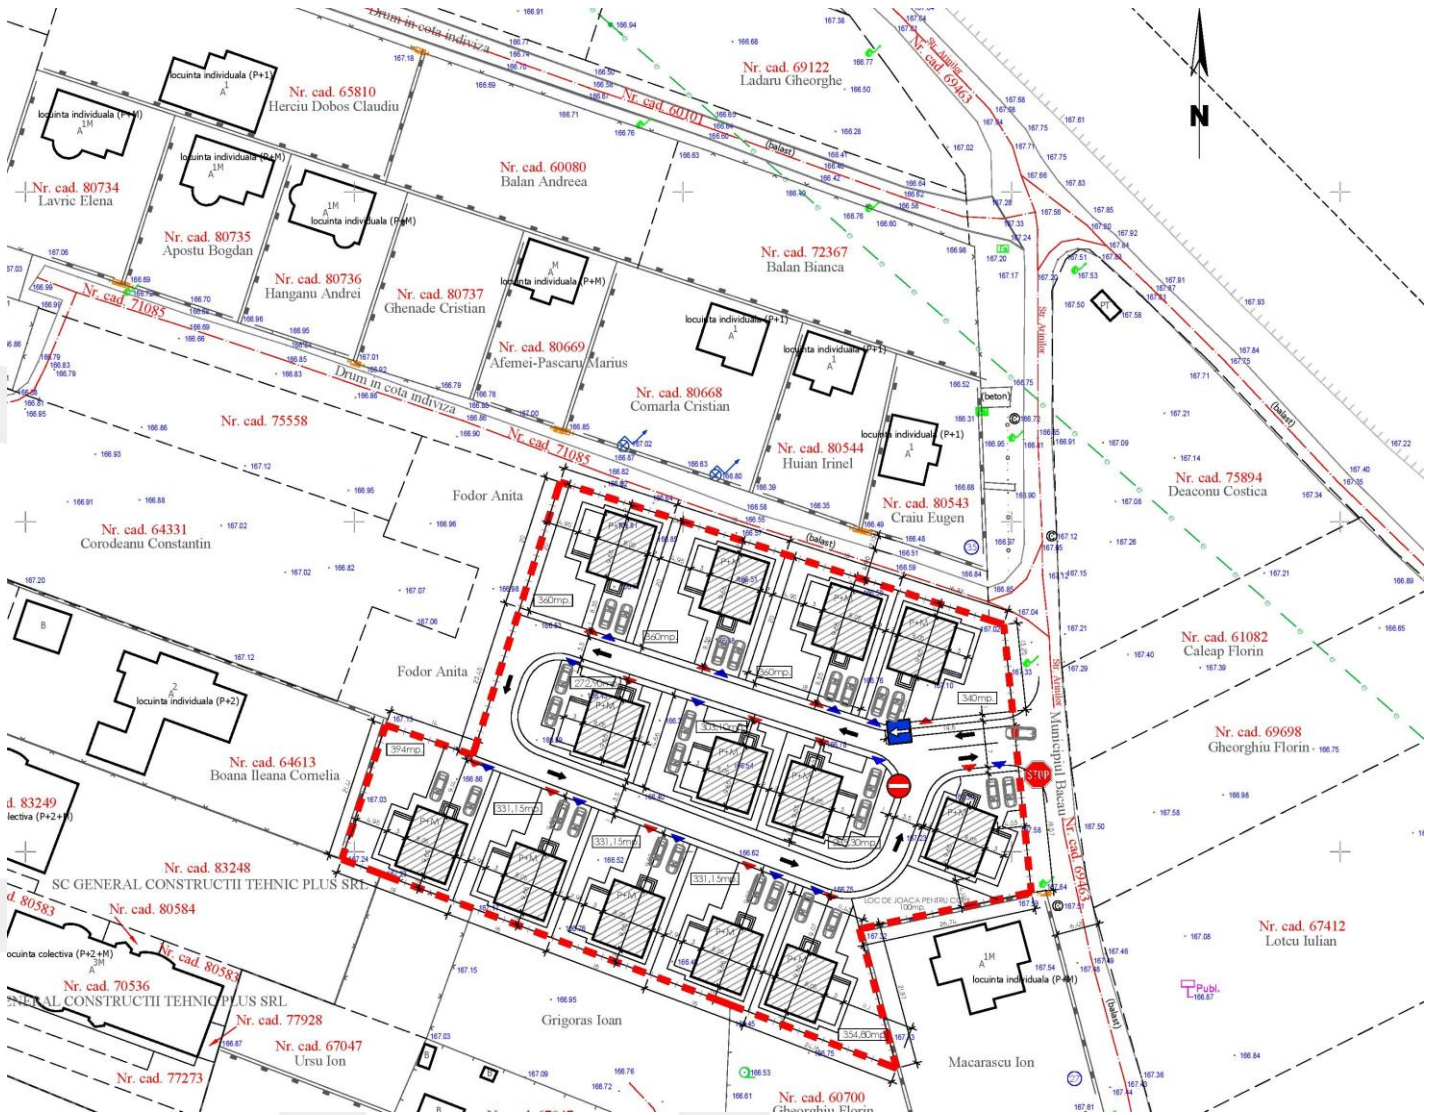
PLAN DE SITUATIE (VECINATATI):
